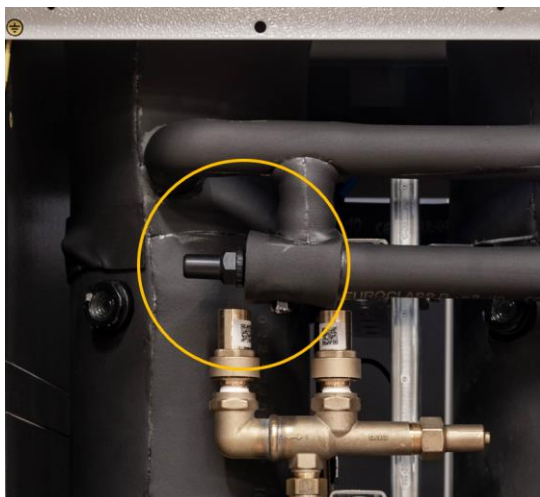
Gros plan sur la vanne d'arrêt à l'avant de la bouteille réservoir sur groupes bi-compresseurs
